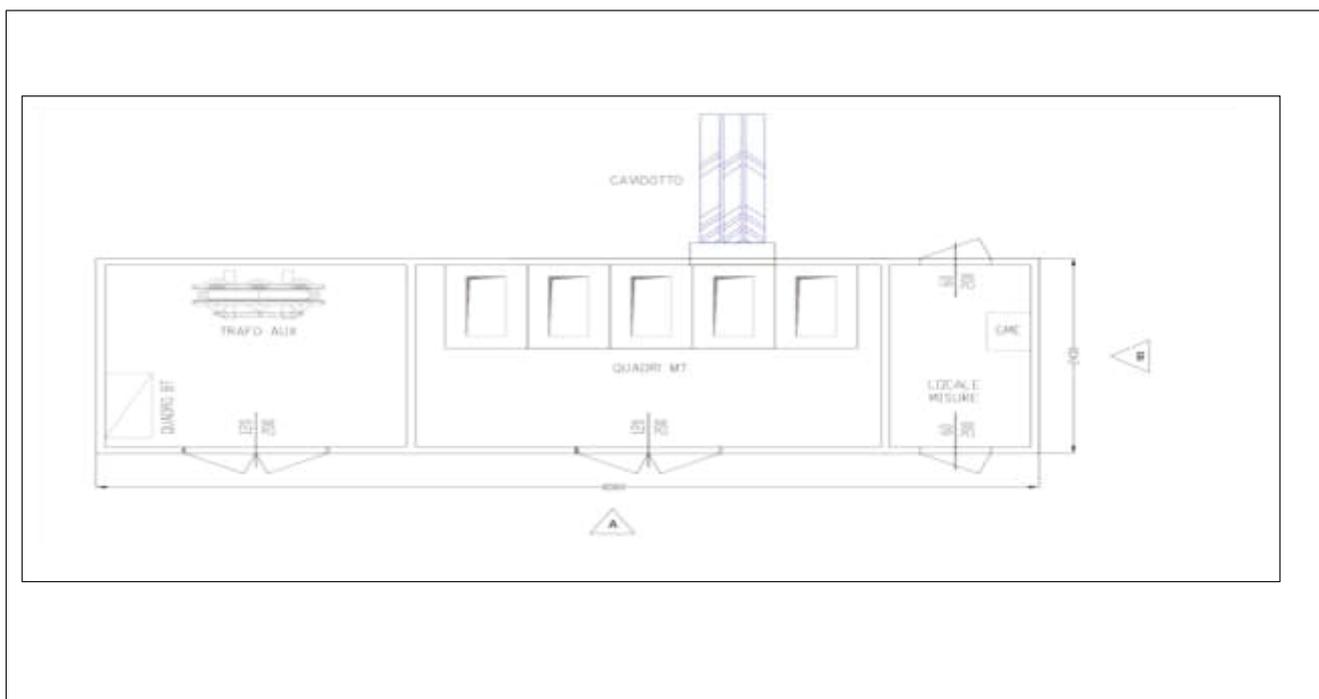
Locale cabina di Parallelo MT-Prospetto
